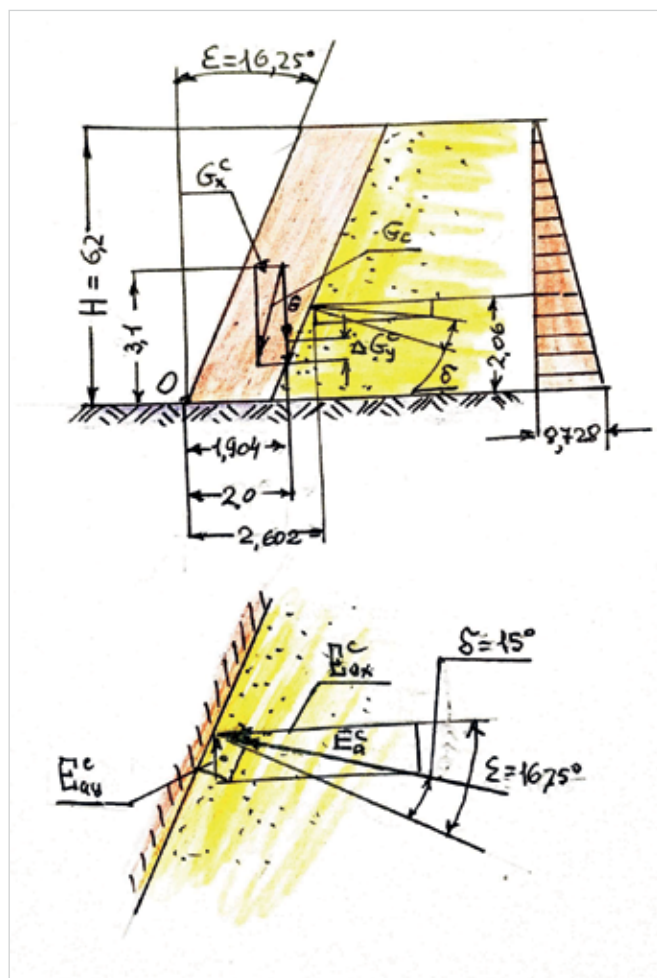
Расчетная схема подпорной стены устоя моста для расчета устойчивости положения на опрокидывание
